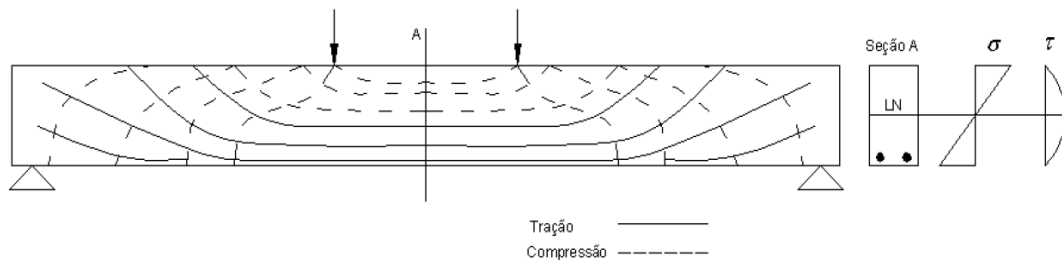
Trajetória das tensões principais em vigas não fissuradas
